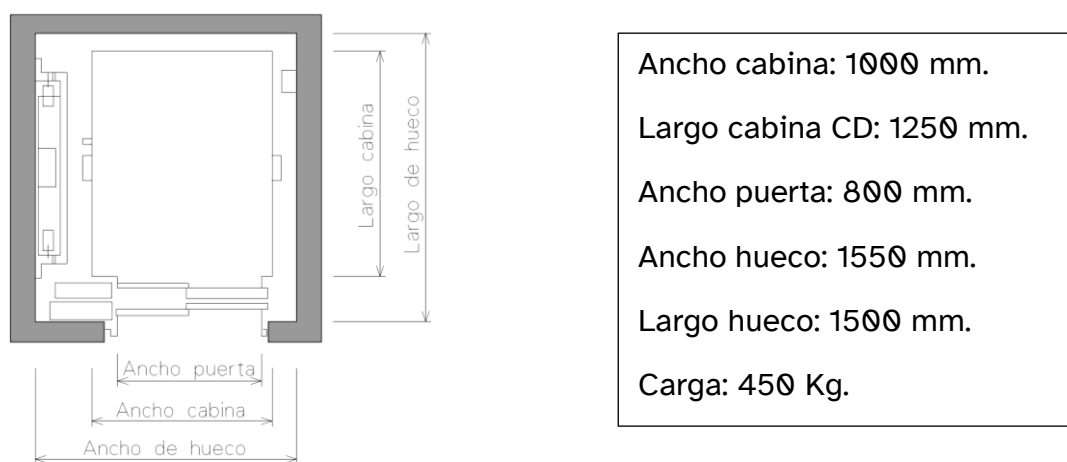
Planta de ascensor con un embarque y puertas automáticas en cabina y piso.
